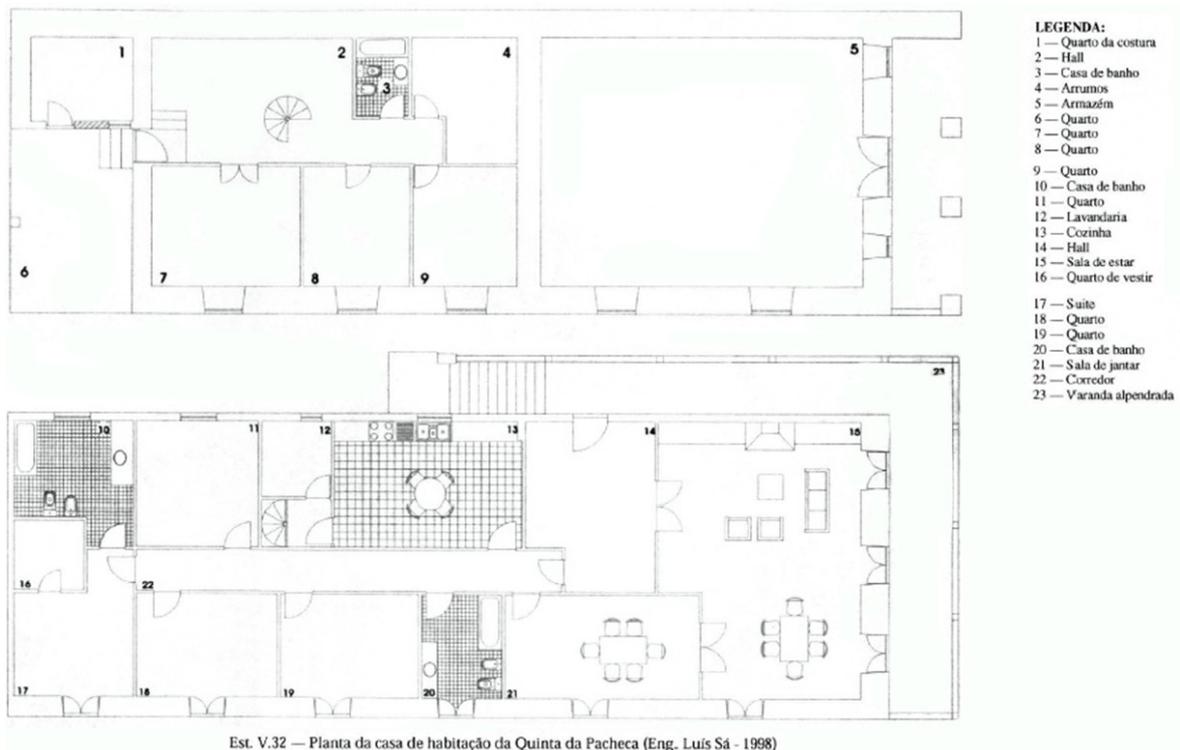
Planta da casa do proprietário da Quinta da Pacheca (retirado de [5])
